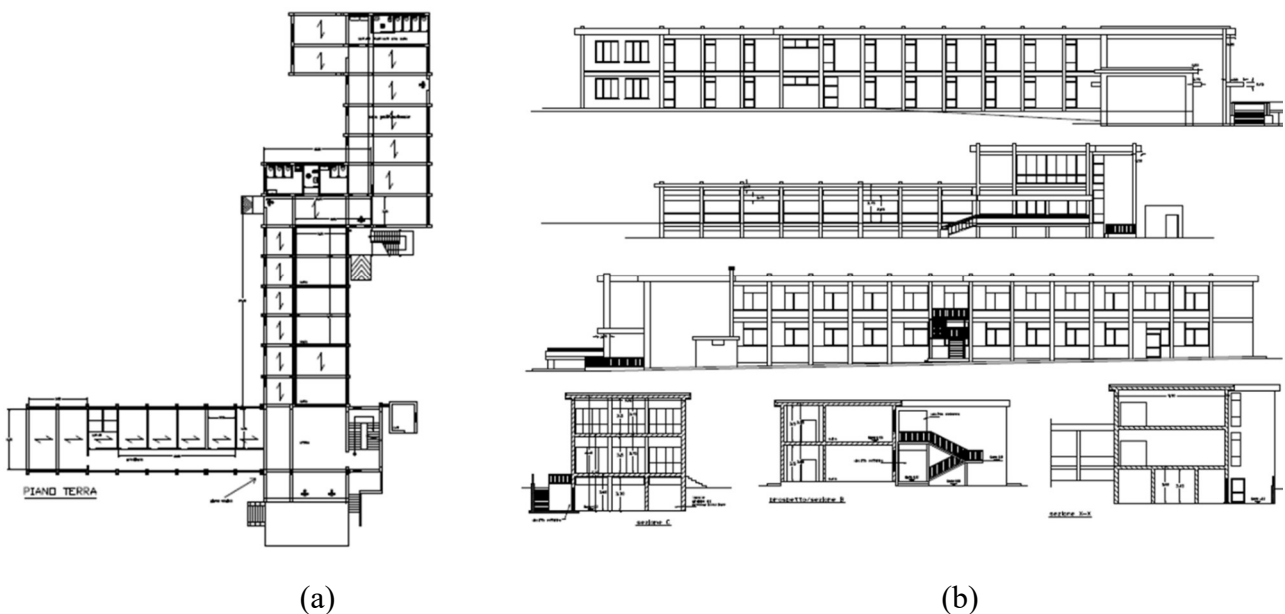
Pianta del piano terra (a) e prospetti e sezioni (b).
